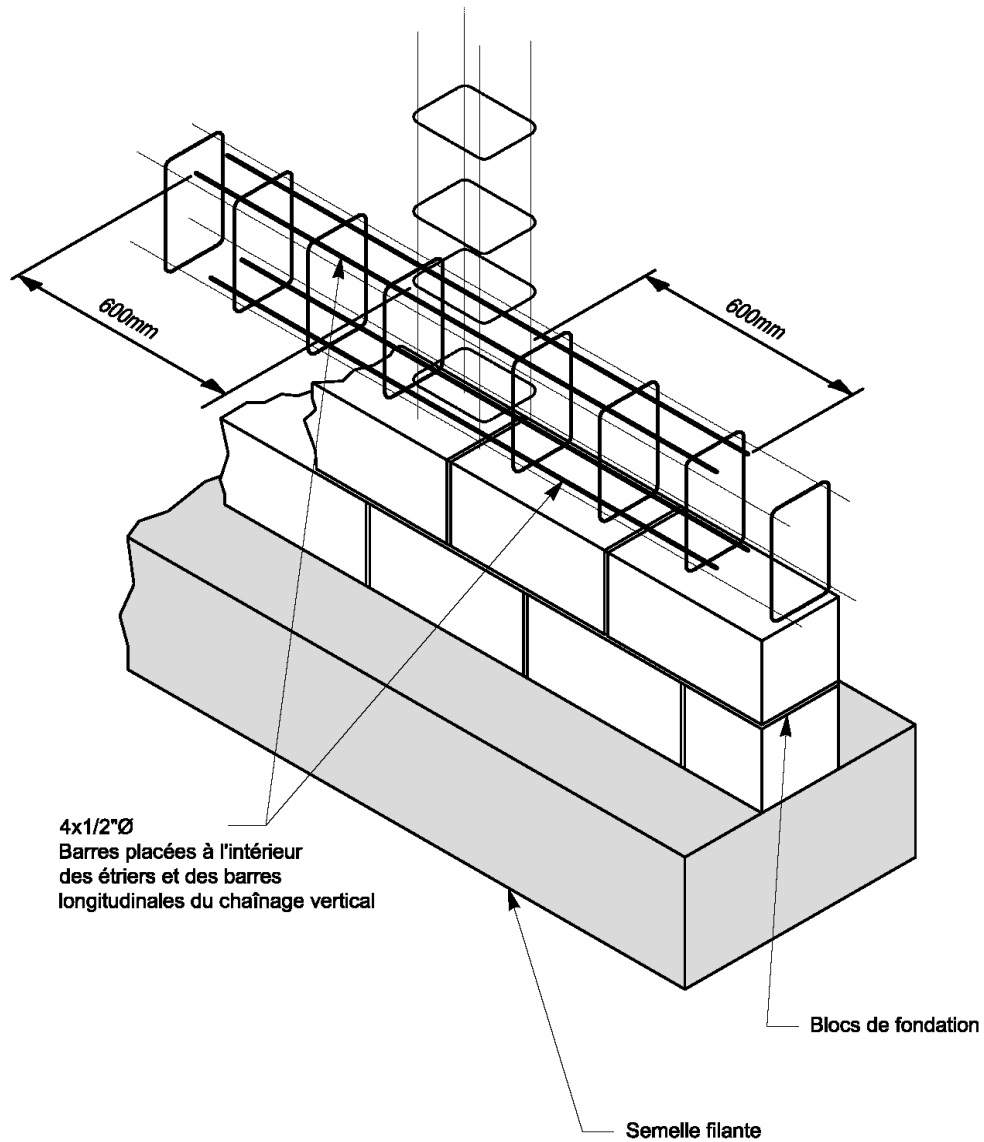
a - Jonction chaînages horizontaux-chaînage vertical sur un mur
